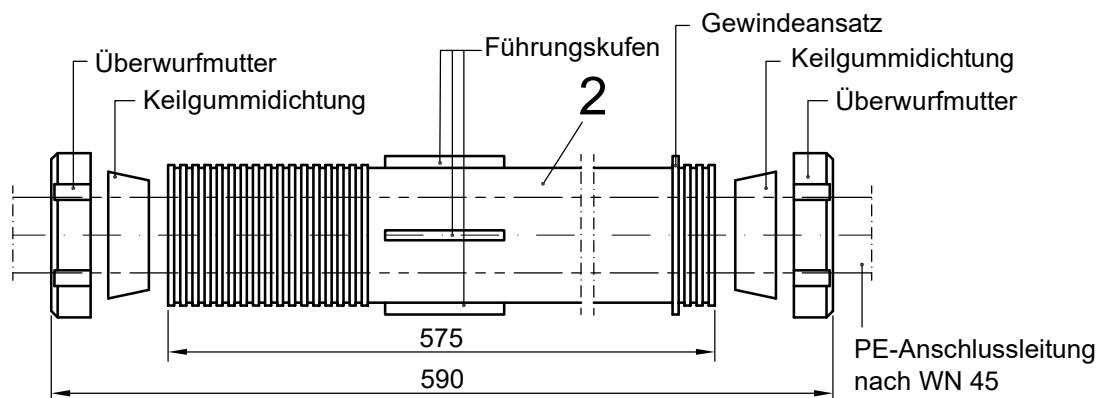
Futterrohr mit beidseitiger Überwurfverschraubung (Prinzipskizze)
